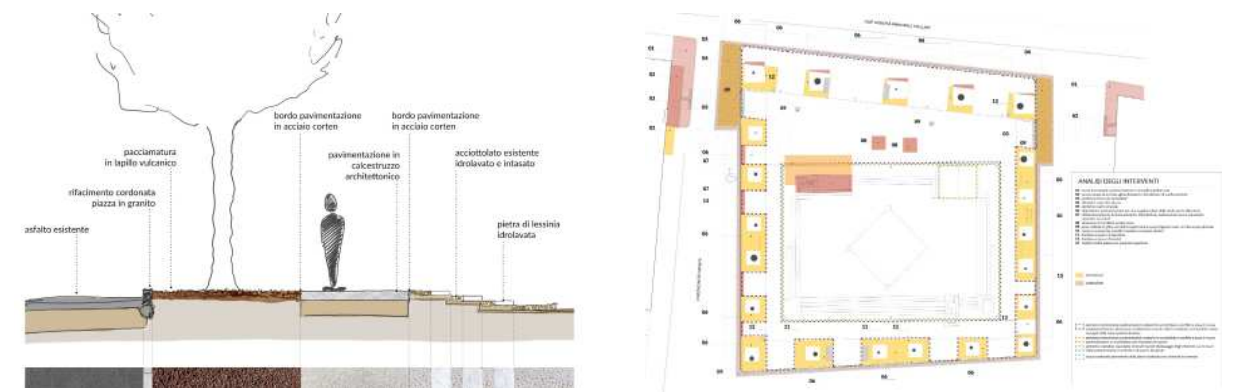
Fig. A _ Intervento sulle pavimentazioni, stato attuale
